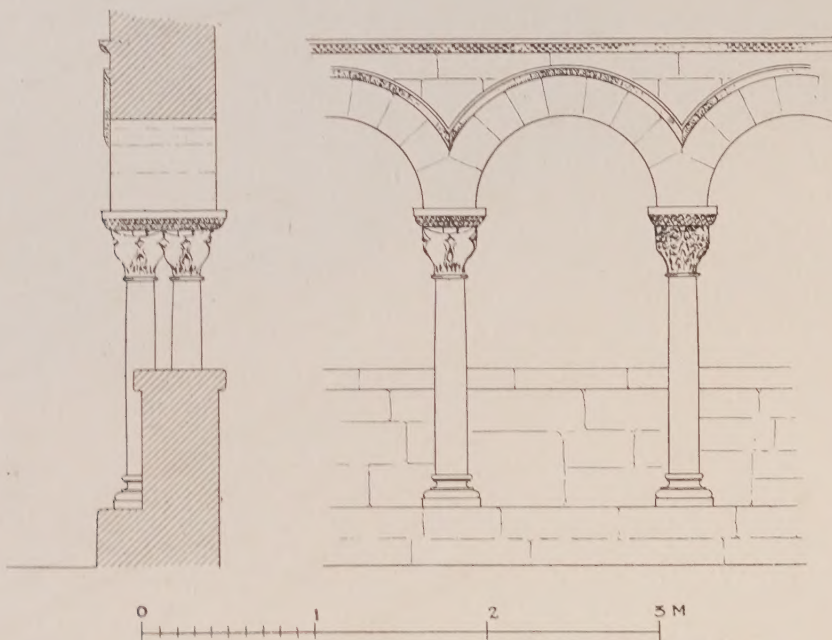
Cloître du rez-de-chaussée. (Coupe et élévation).
